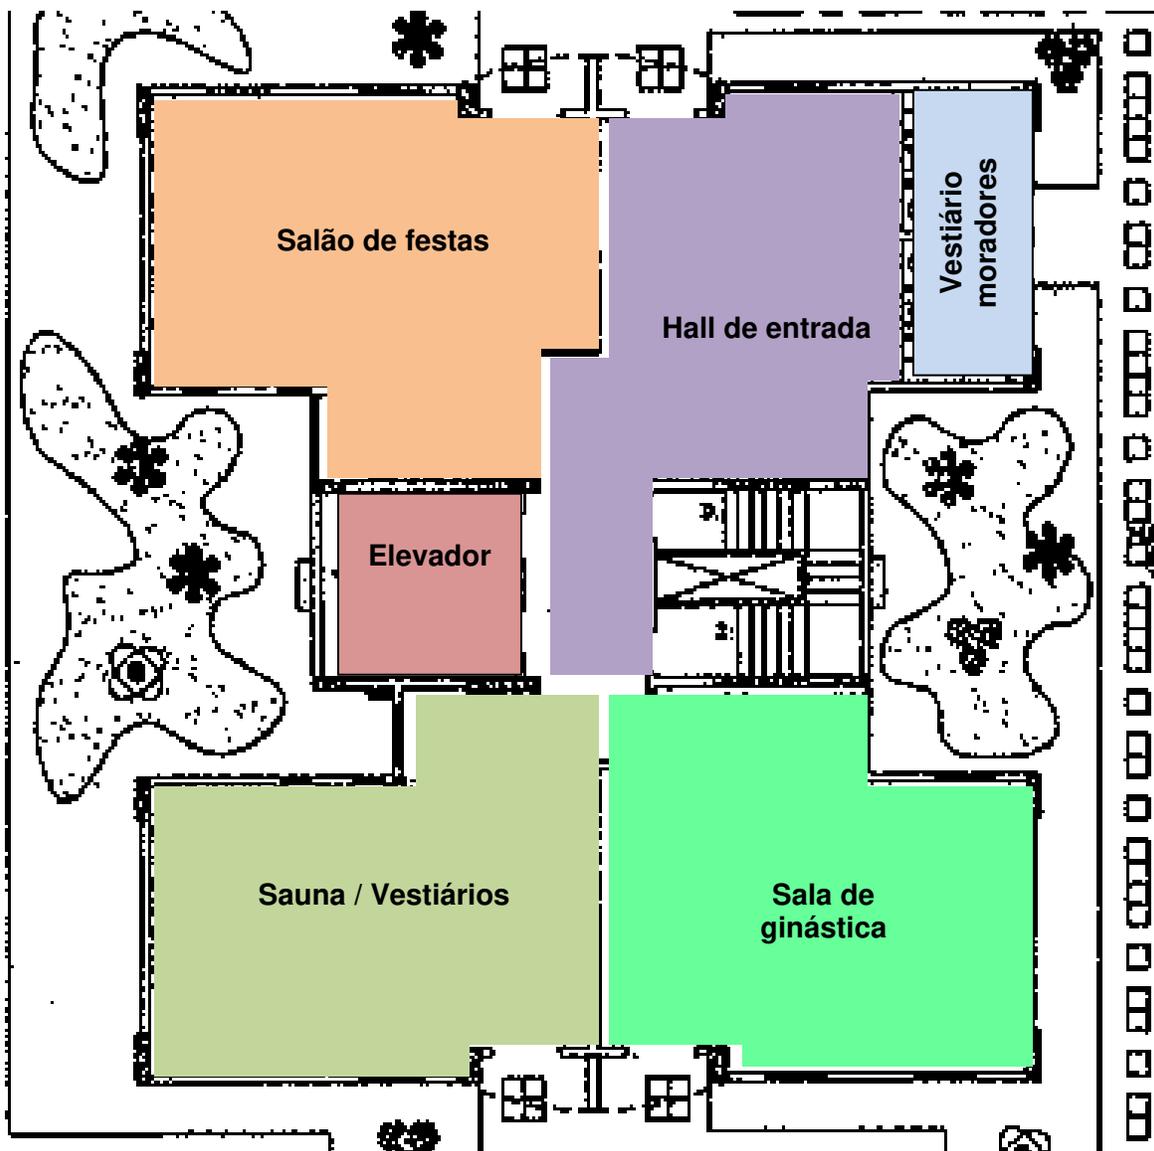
Edifício Saint Tropez. Fonte: a partir da planta original de implantação e paisagismo.
